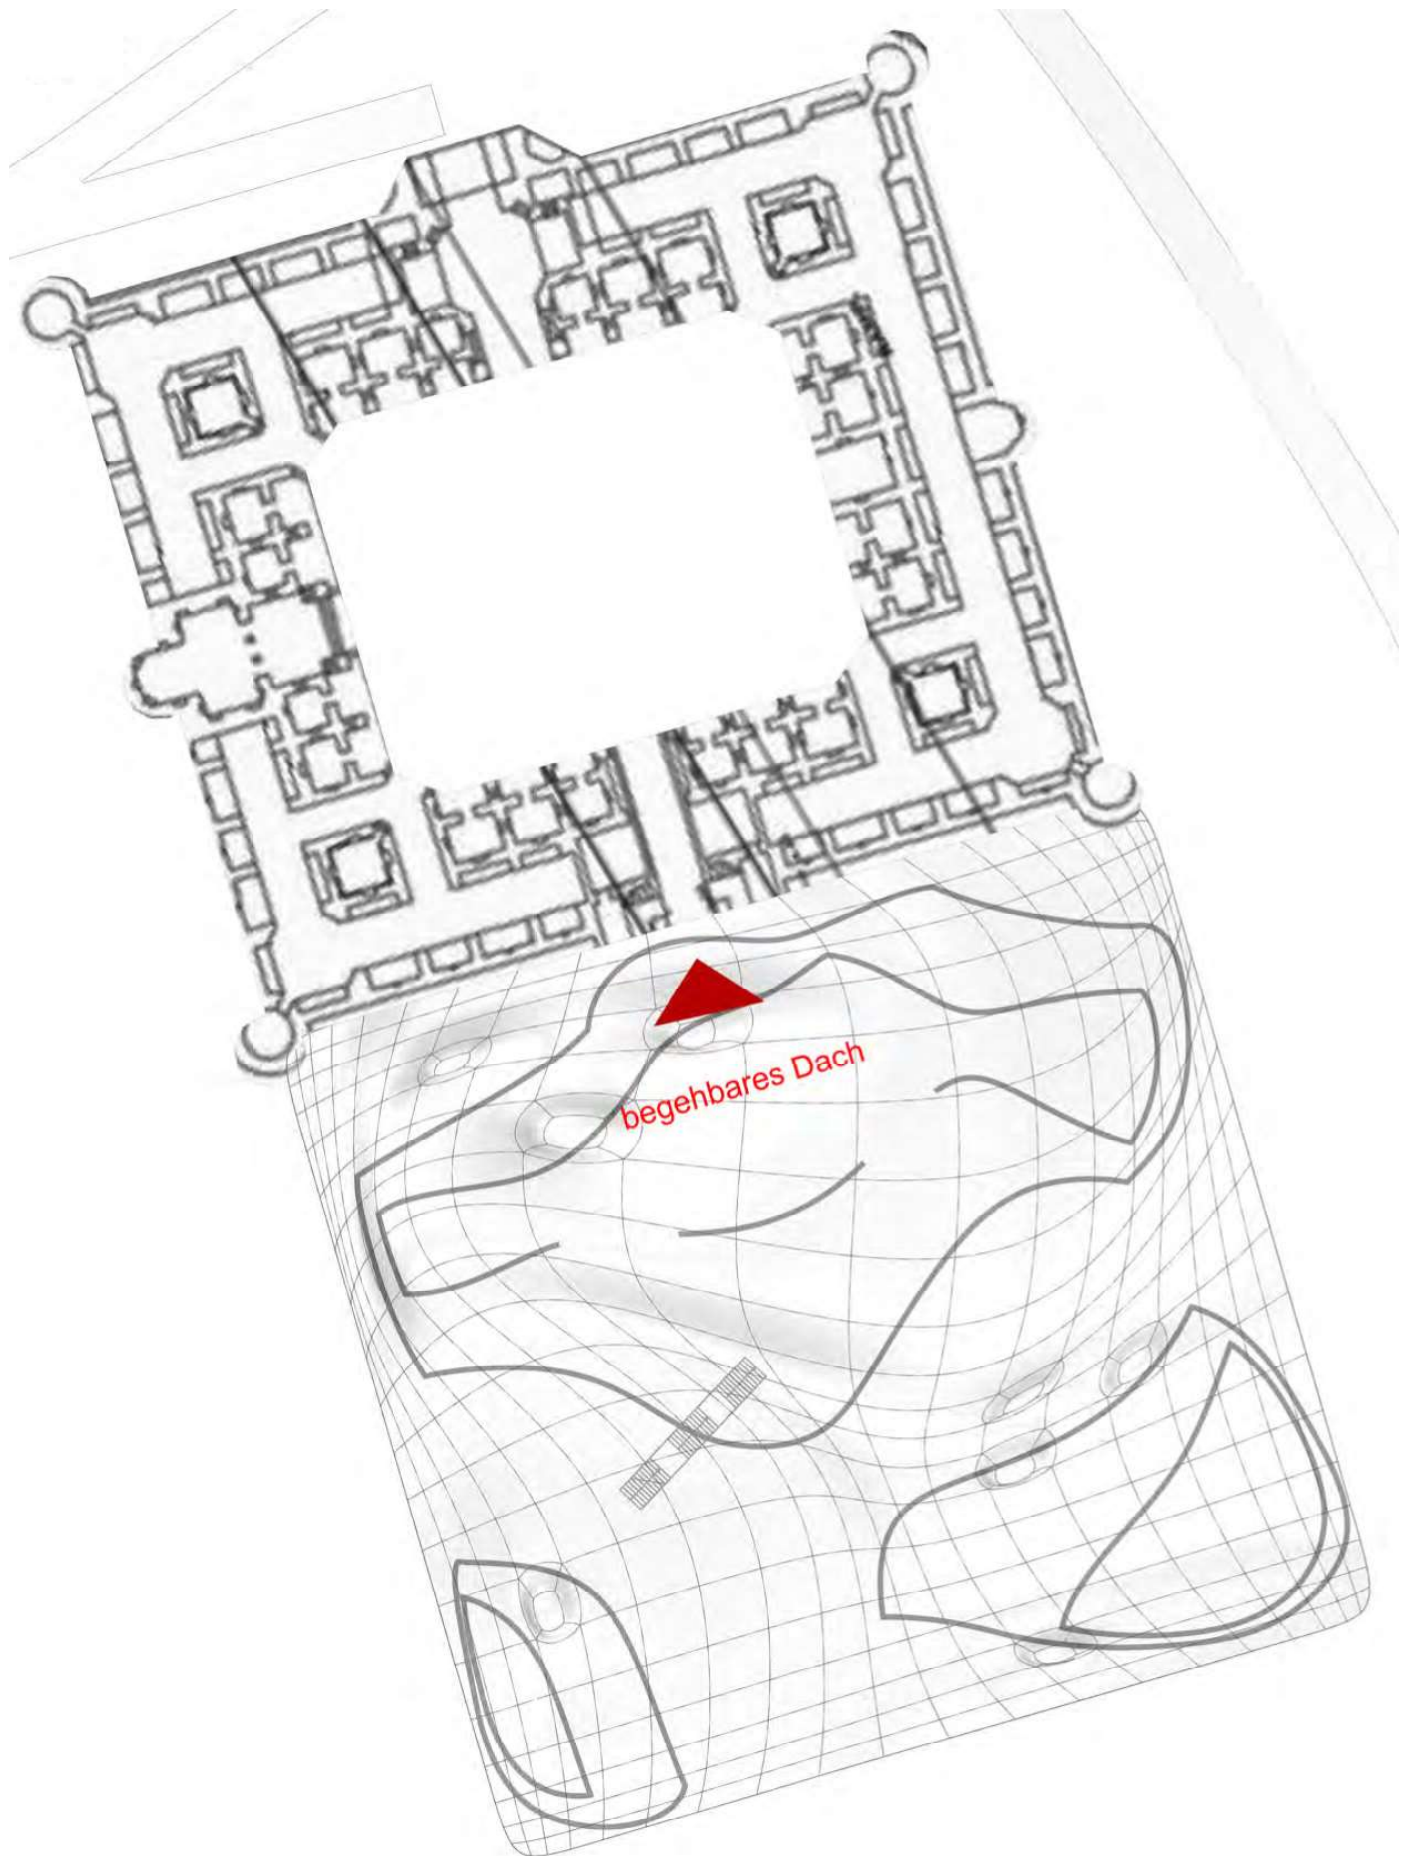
Formfindung, Dachgeschoss, Grundrisskonzept
